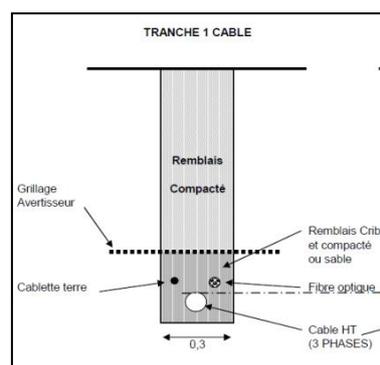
Coupe type d'une tranchée pour le câblage interne
